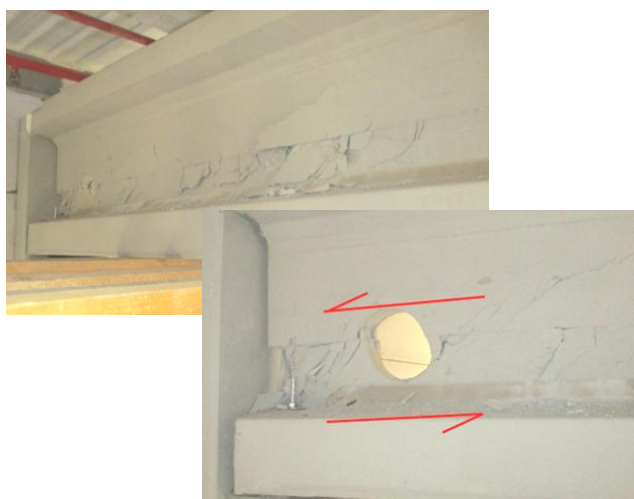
Fallo a rasante en una de las vigas de la cubierta prefabricada de una nave industrial construida en 2009
